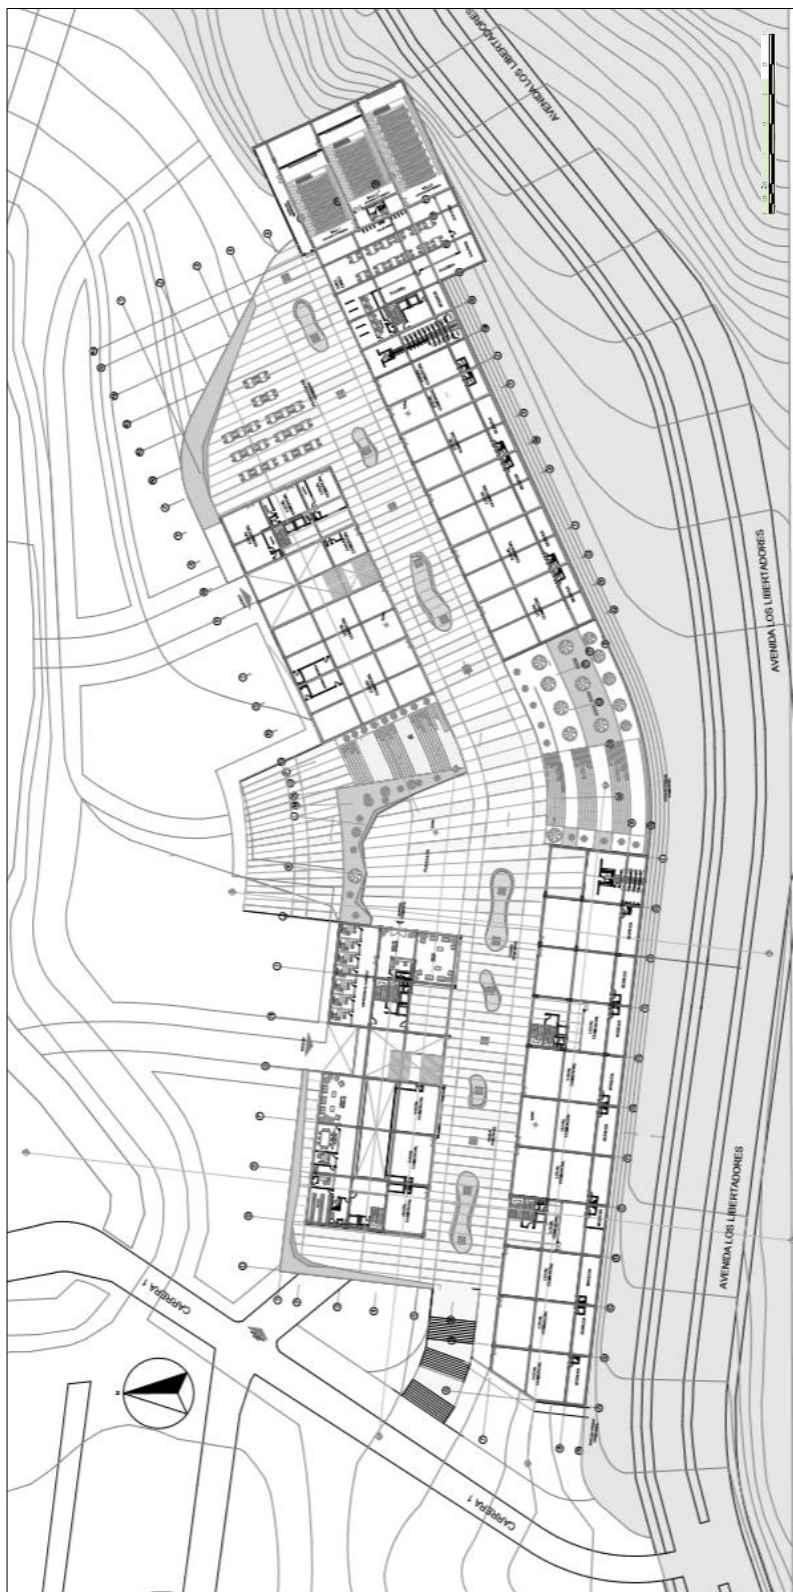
Planta arquitectónica nivel-1 eje comercial
